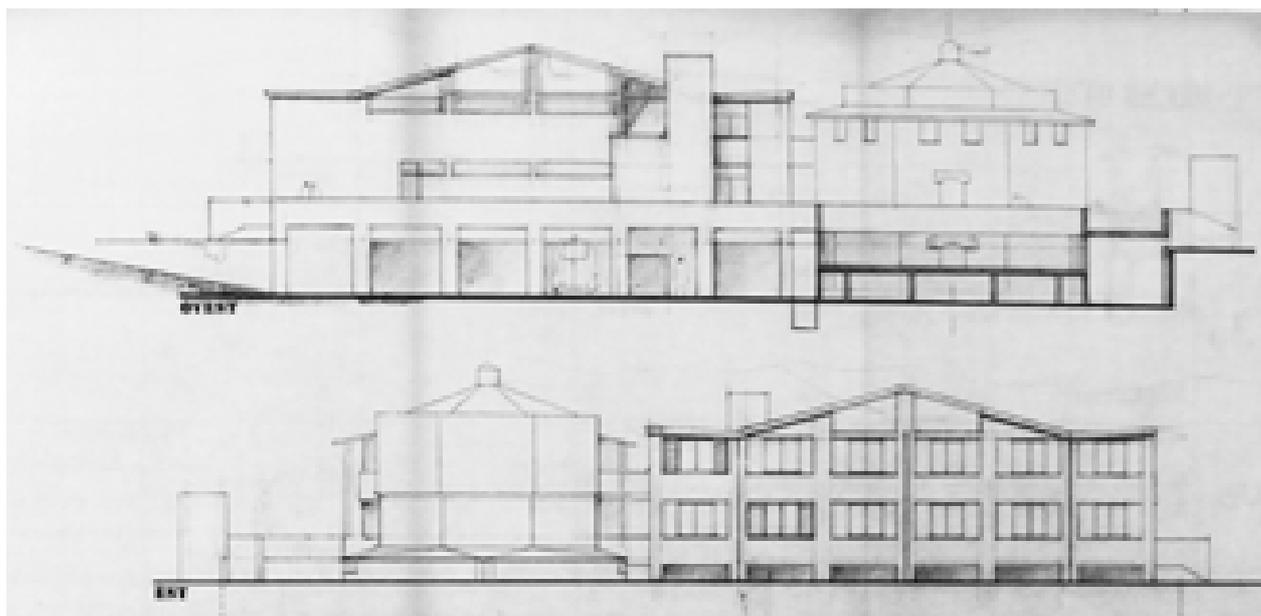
Prospetto Est-Ovest, stato attuale – 28/03/1995 (AABS-64_832)
